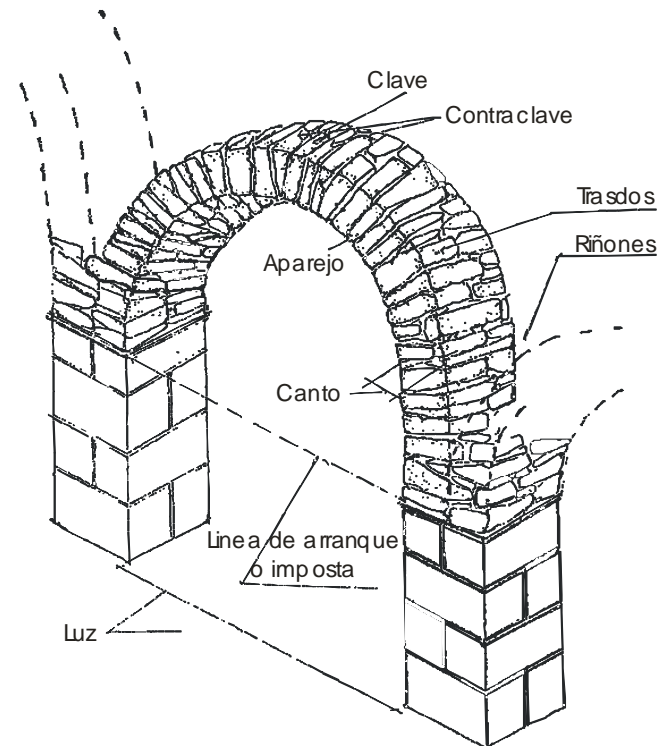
Detalle constructivo de arco de piedra aparejada.
